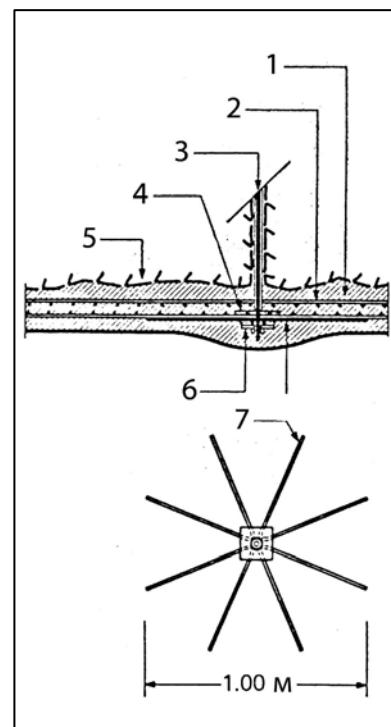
Крепление арматурной сетки вязальной проволокой
